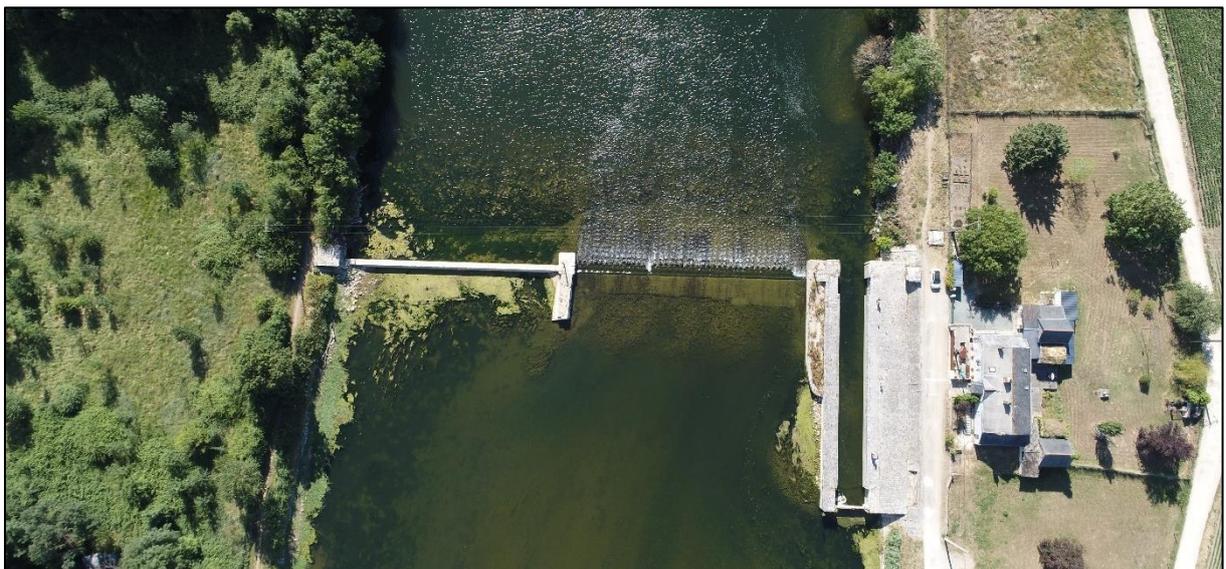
Barrage de Larçay. S.Bondoux, PURBS.
